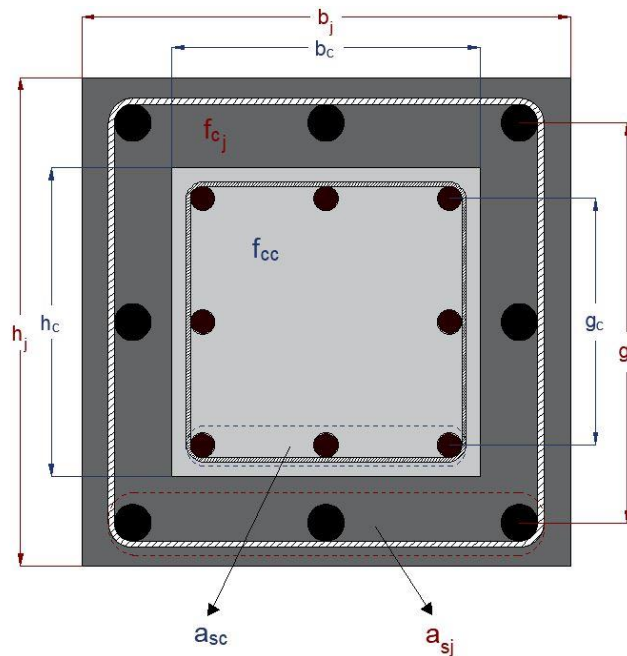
Elementos de sección transversal utilizados para el cálculo de la resistencia a flexión con el Modelo 6
